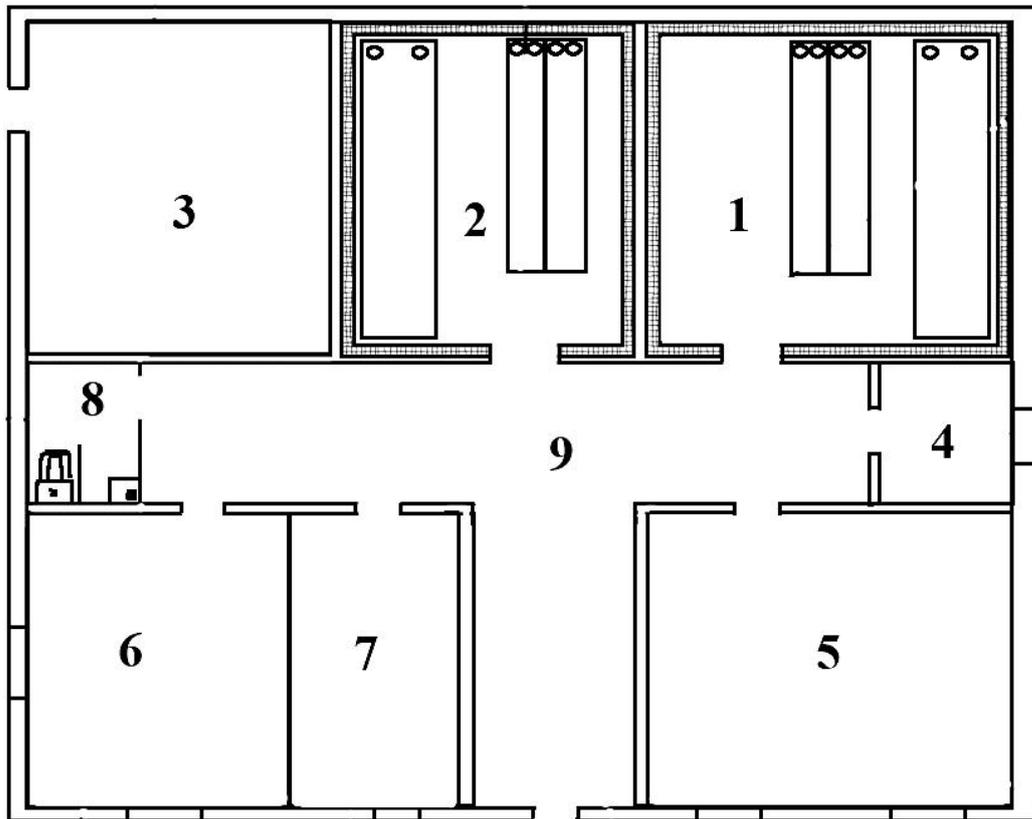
План типового склада 709-54 для длительного хранения до 5 т семян хвойных пород с охладительными камерами до -10°C : 1,2 - охладительные камеры; 3 - машинное отделение; 4 - помещение для подсушки семян; 5 - помещение обработки семян; 6 - помещение оператора склада; 7 - помещение мойки бутылей; 8 - санузел; 9 - коридор
